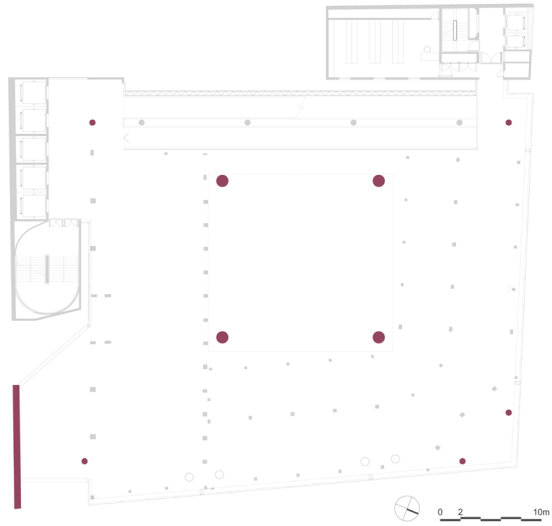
Elementos estructurales del conjunto 2. (Autoría propia, 2022).
